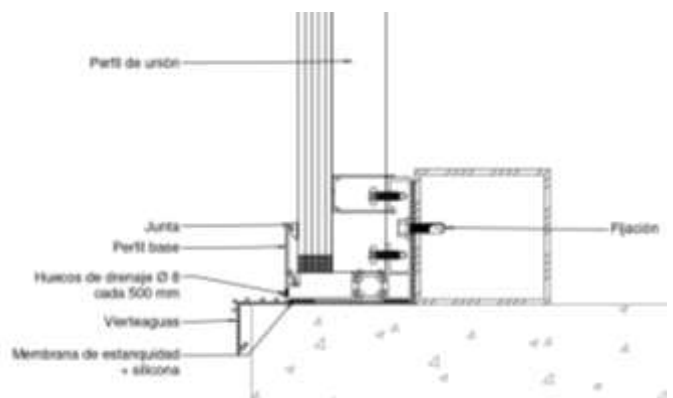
Arranque del sistema como cerramiento de fachada.
